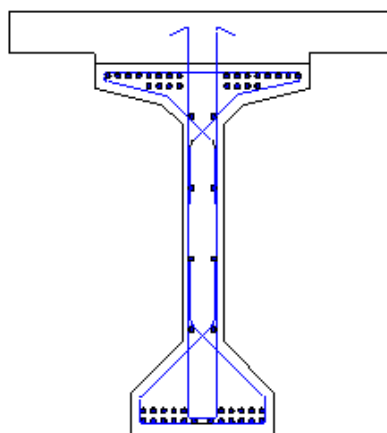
Visualización del acero de refuerzo transversal de la sección viga para cargas transitorias y peatonales.
